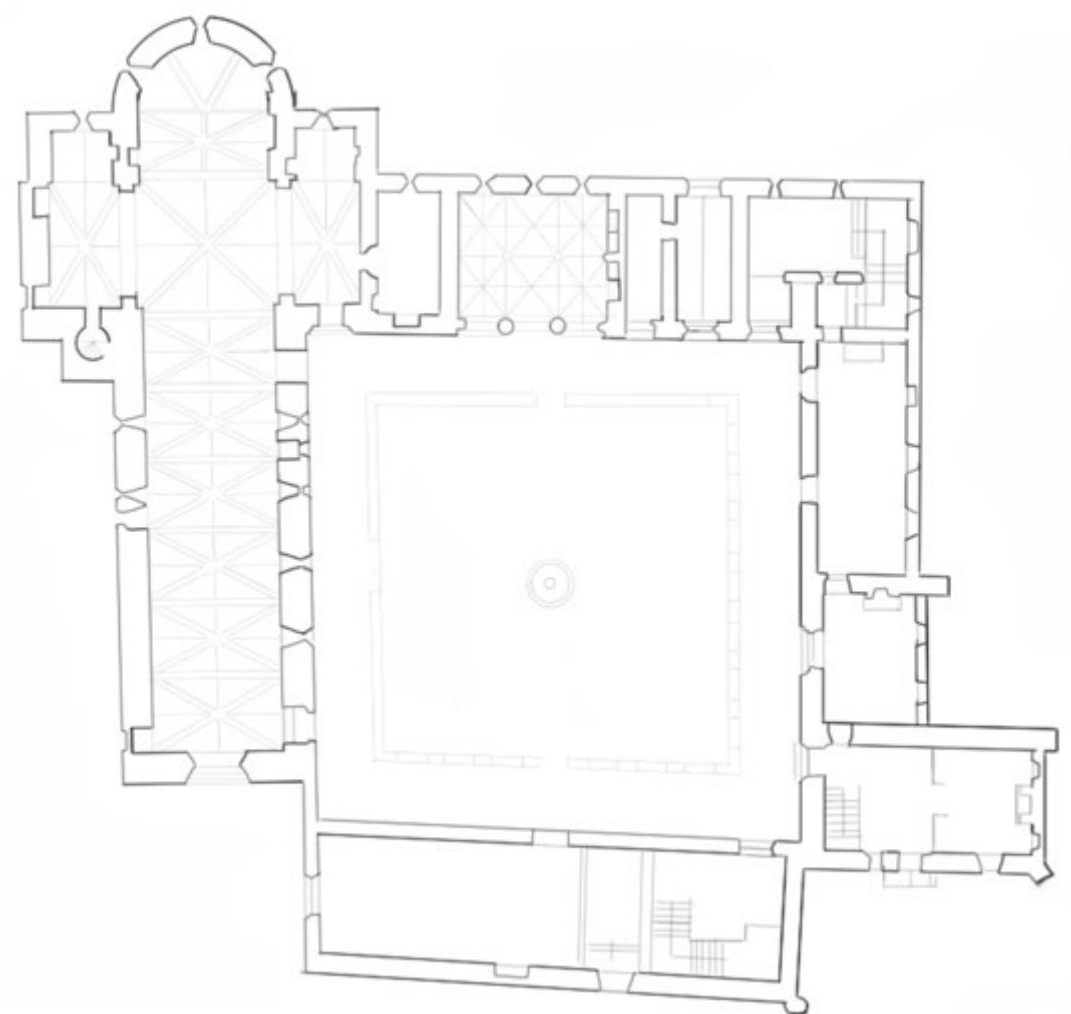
Bujedo, Santa María, Grundriss Gesamtanlage, Ruíz Souza, 1998.
